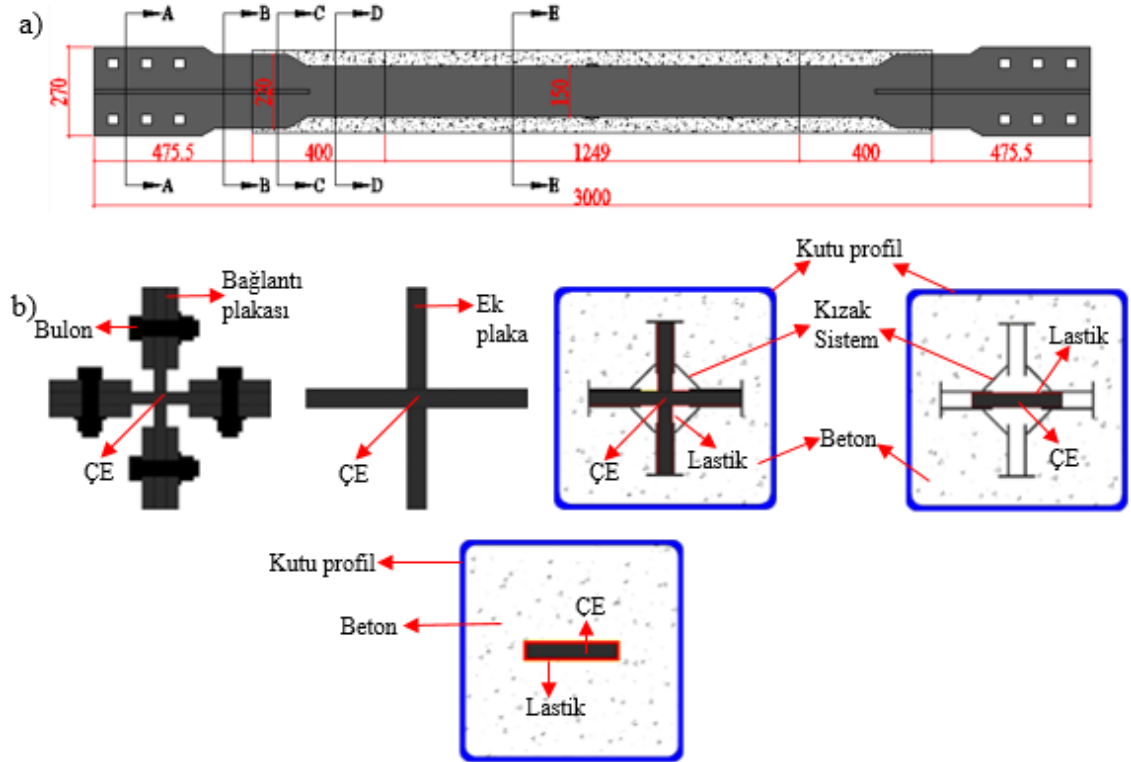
2.BEÇÇ elemanına ait detay çizimleri (FBA-2014-79 nolu proje)
